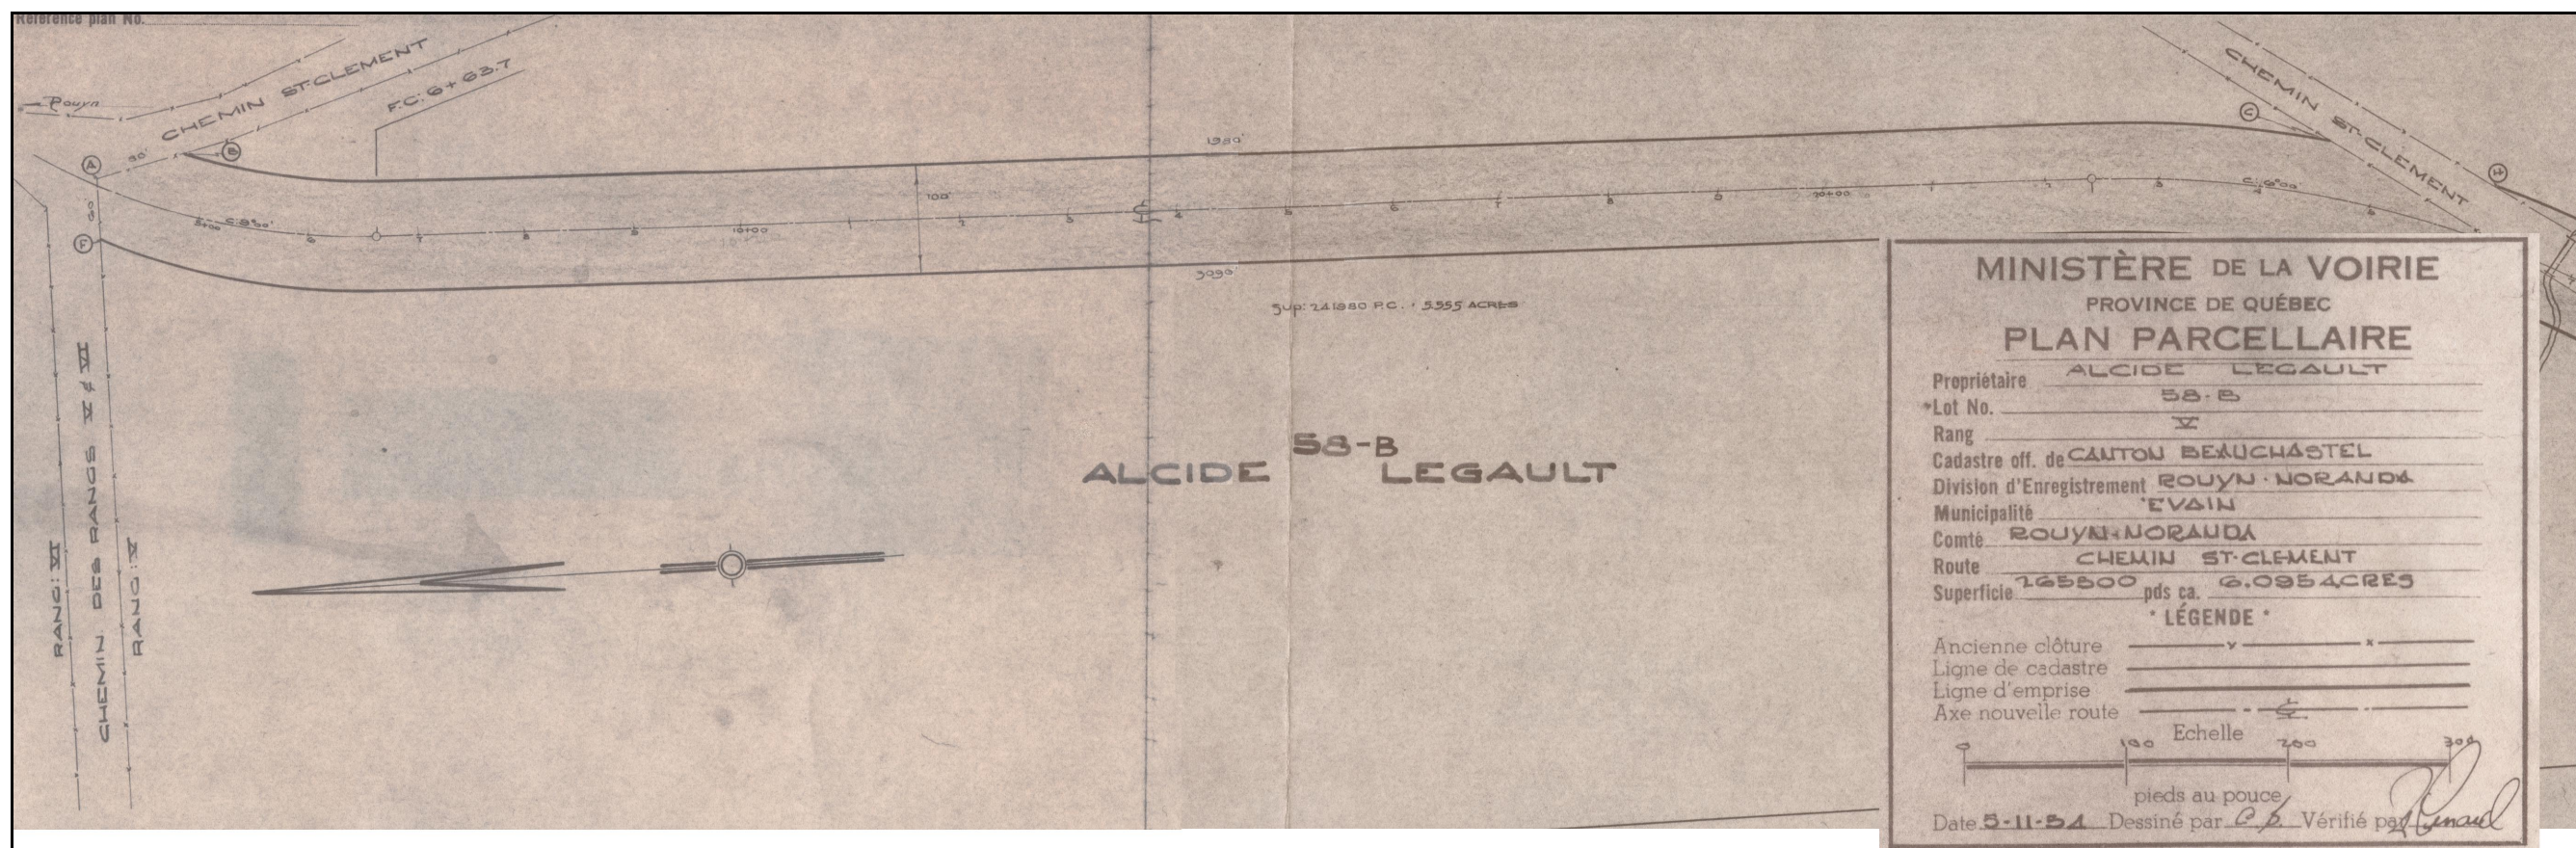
Plan parcellaire de 1954 (extrait du plan original).
